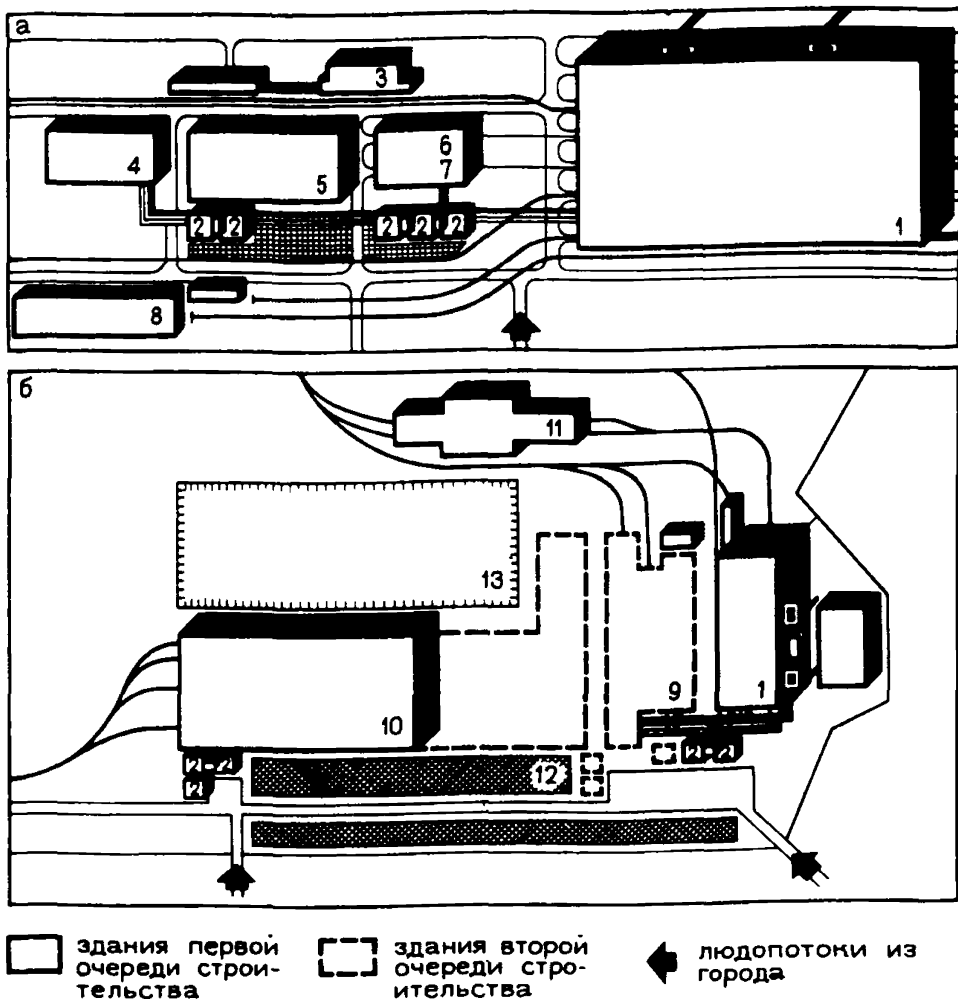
Схемы генеральных планов комплексов ЭСПЦ
